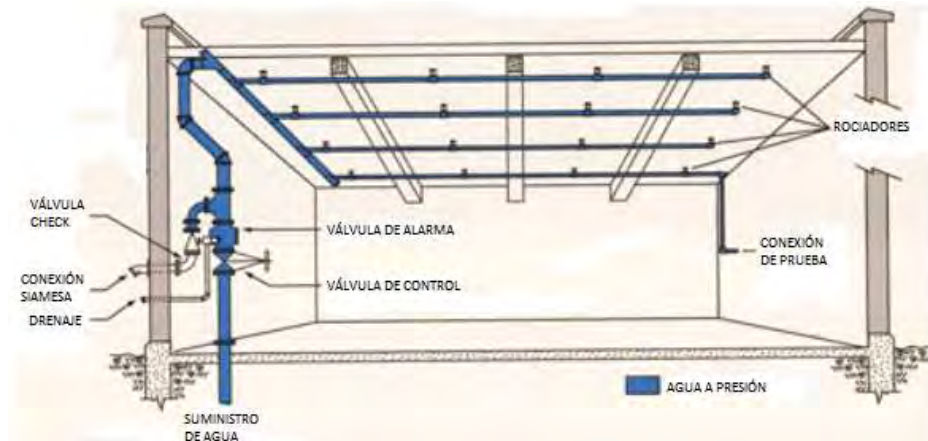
Sistema de tubería húmeda. Fuente: [16]
